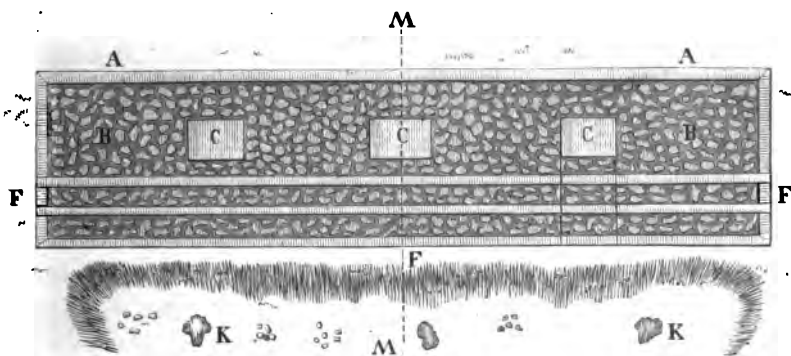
Plan af terrassen; jfr fig. 13 och 14. Efter La Pérouse.
